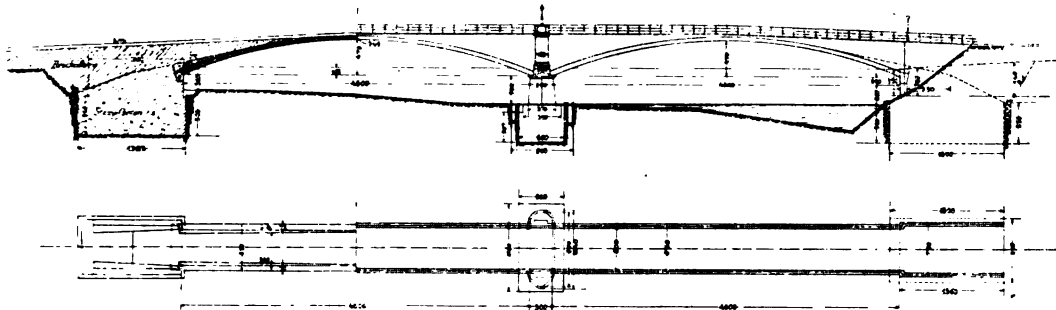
Längsschnitt und Grundriß der Monierbrücke bei Allersdorf.
